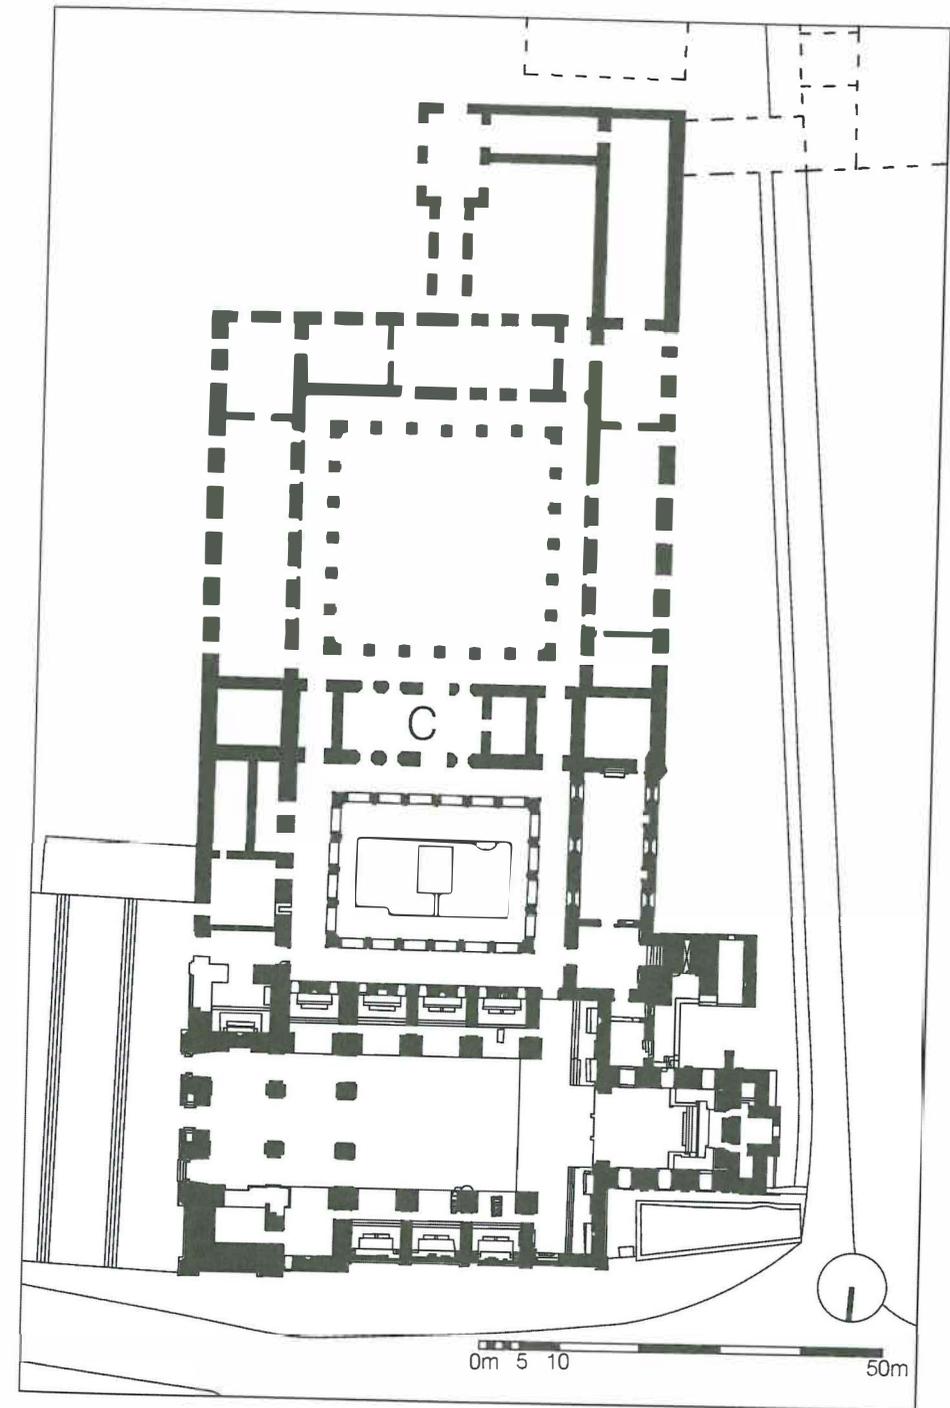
Planta de Implantação do convento de Nossa Senhora da Graça de Velha Goa. A letra C assinala o local da capela do Capítulo.
